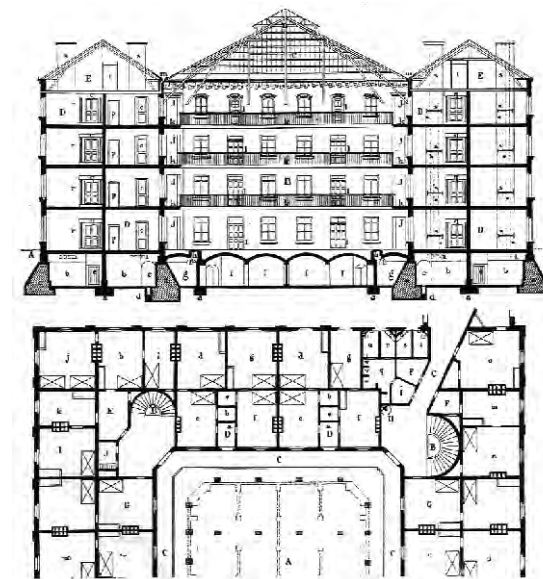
Planta y sección del cuerpo central del Familisterio.
